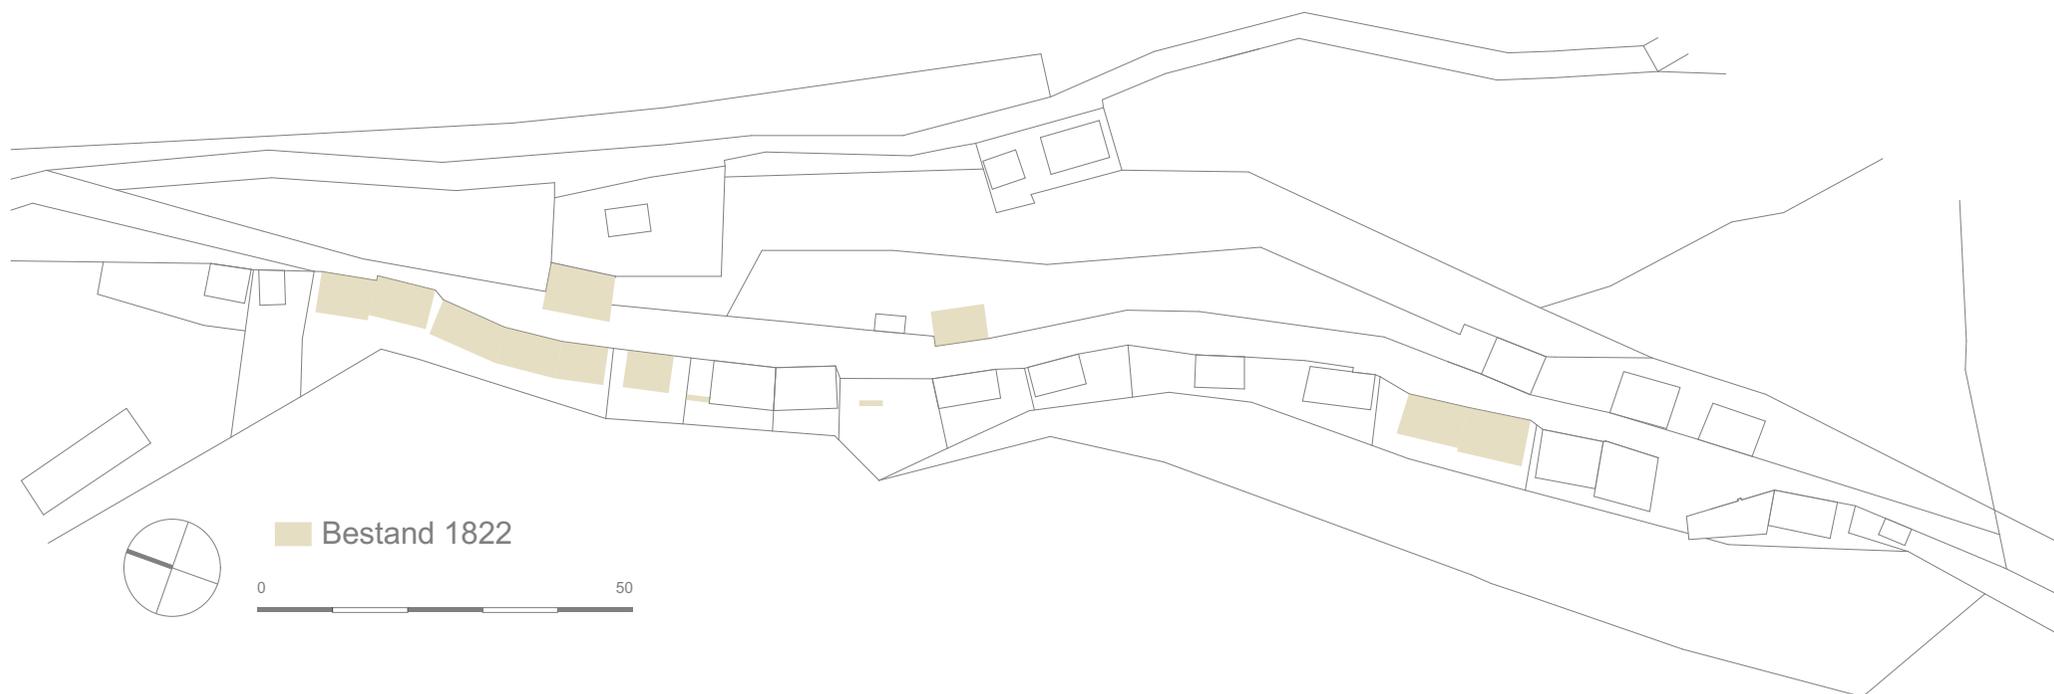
Lageplan Presshausbestand 1822 Maßstab 1:1000
